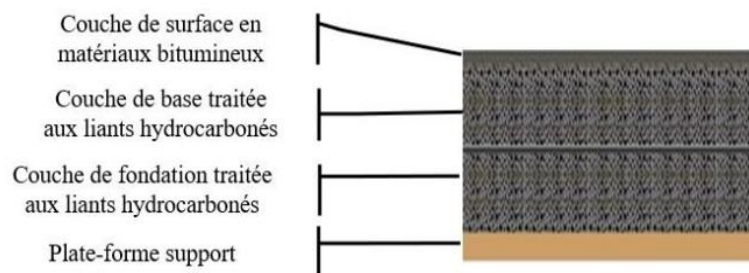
Structure d'une chaussée bitumineuse épaisse (Nguyen, 2008).
